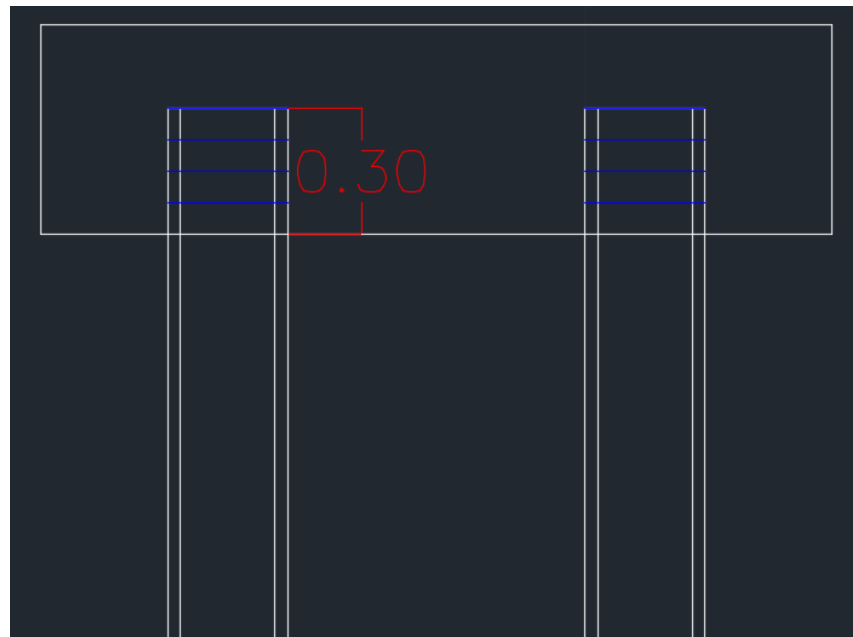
Detalle de anclaje del pilote al dado. Fuente: Elaboración propia
